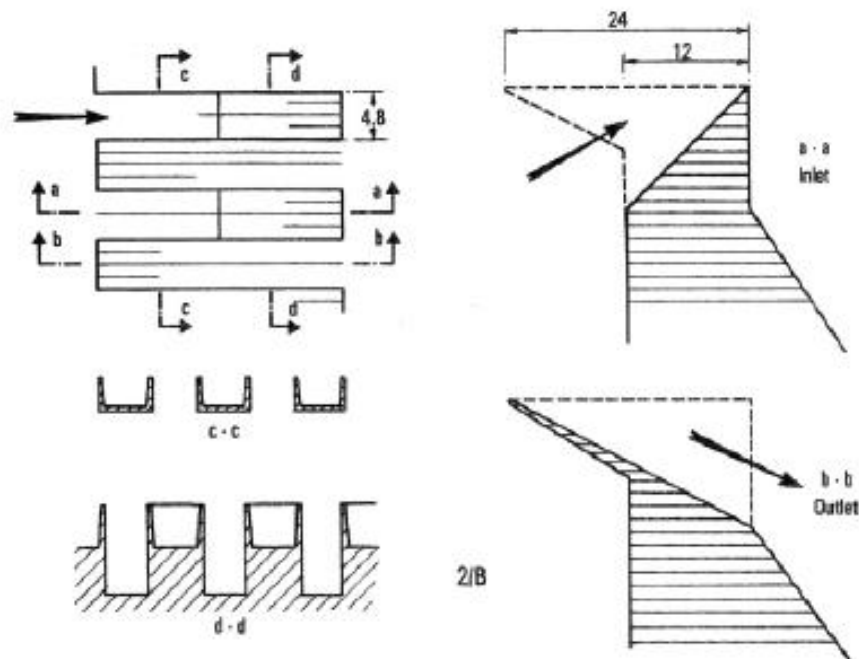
Descarregador em Plano – configuração B (retirado de Schleiss, 2011).
